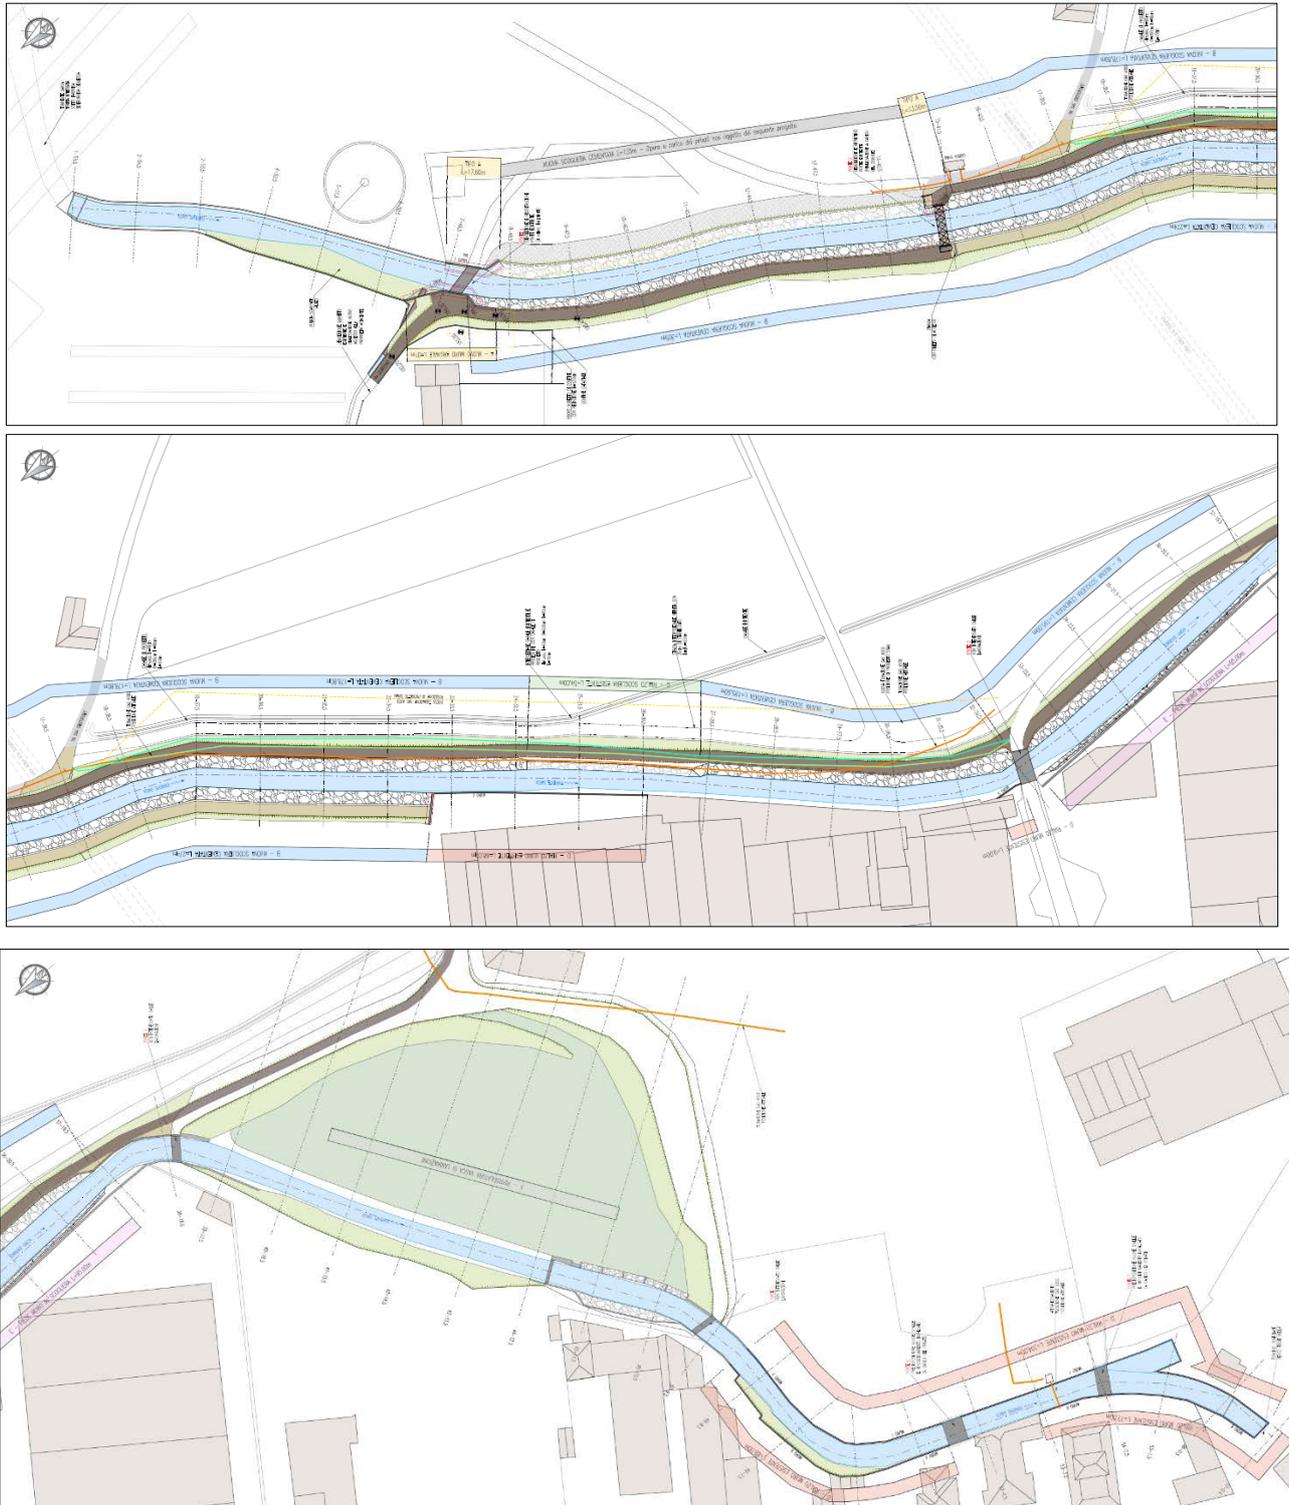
Estratto Tavola 04. Stato di progetto, planimetria generale.
